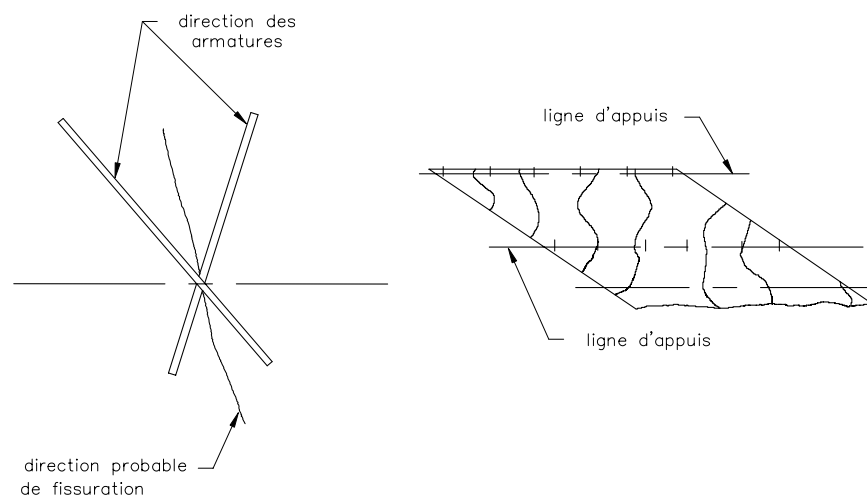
Fissuration d'une dalle biaise
